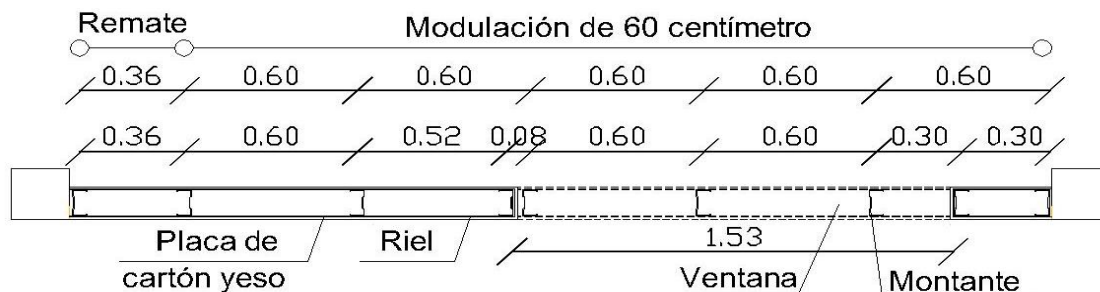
Vista en planta de la distribución de los montantes verticales en pared con ventana
